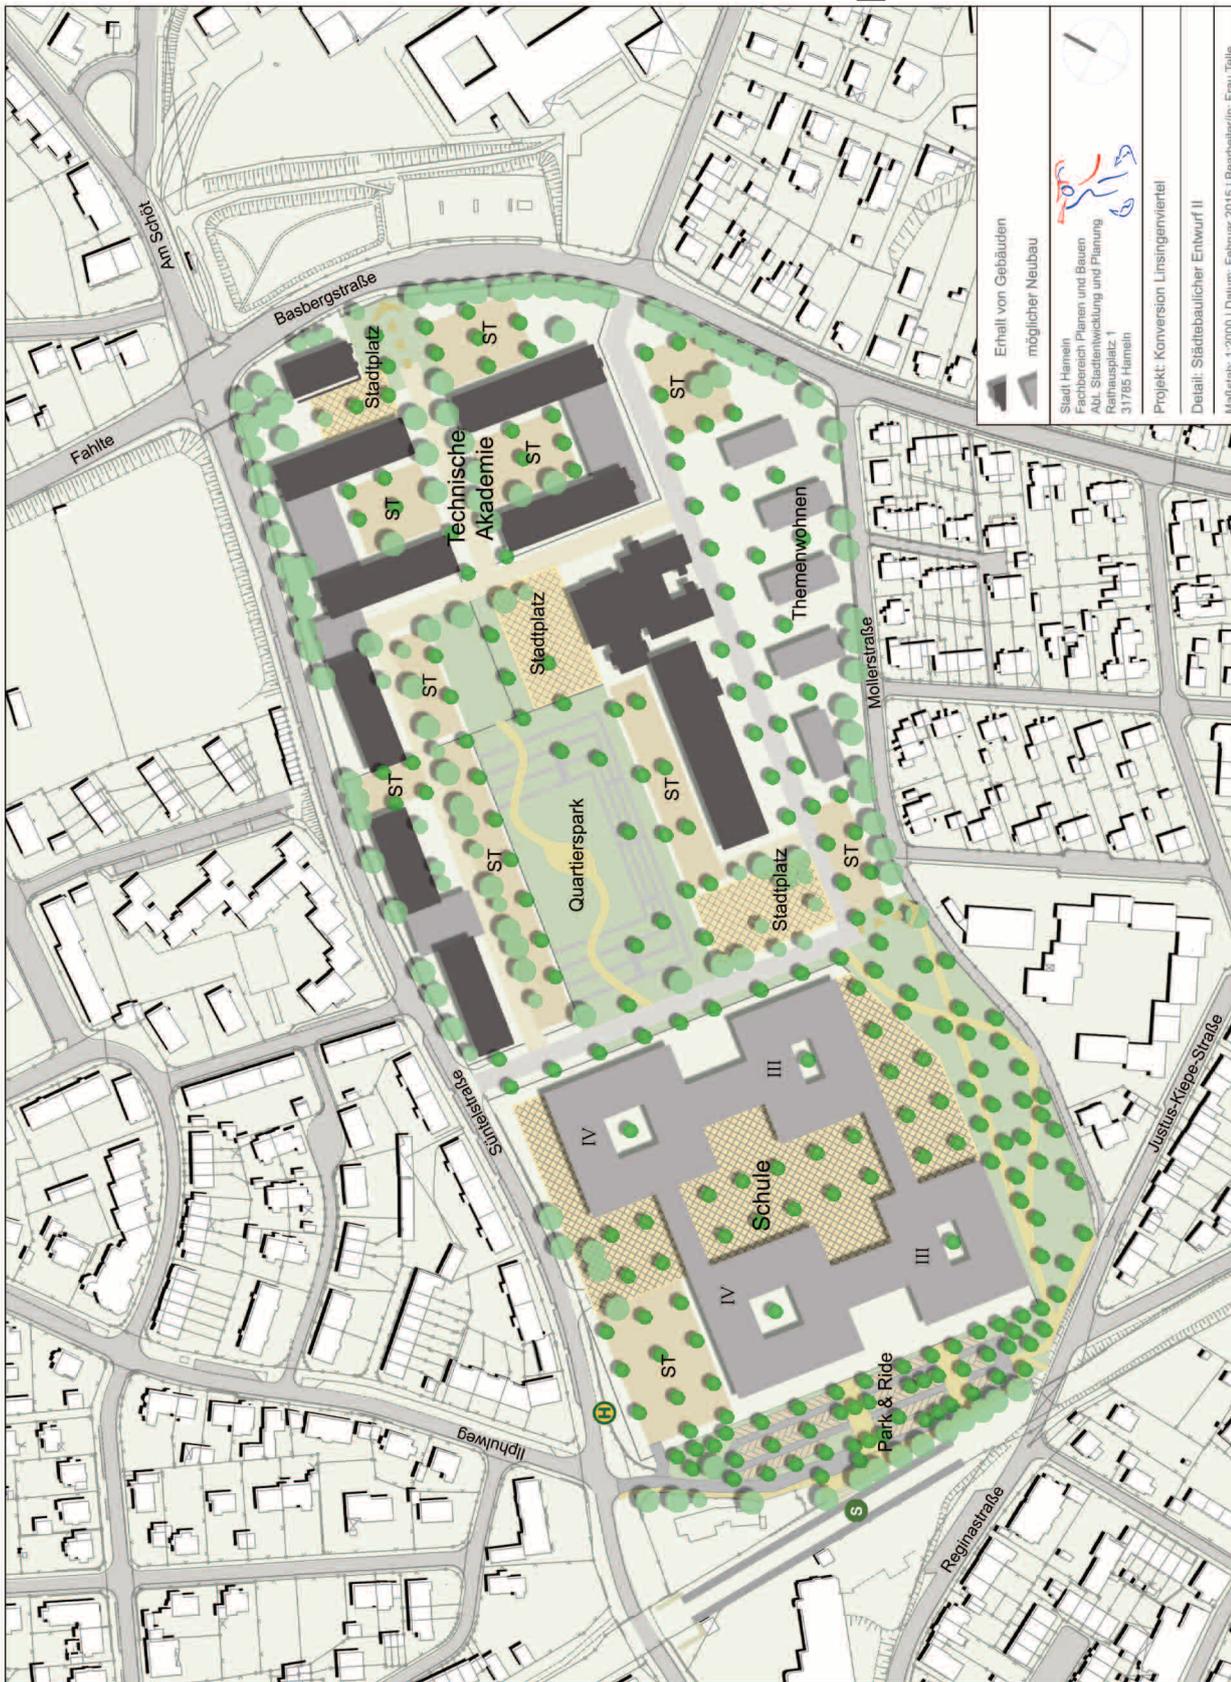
Städtebaulicher Entwurf Linsingen V2. Quelle: Stadt Hameln, 2014
